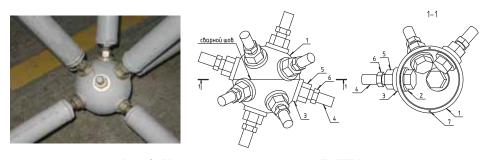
Узловой элемент системы «БрГТУ»: 1 — полусфера; 2 — внутренняя шайба с выпуклой поверхностью; 3 — наружная шайба с вогнутой поверхностью; 4 — болт; 5 — силовая гайка; 6 — контргайка, 7 — центрирующий штифт
